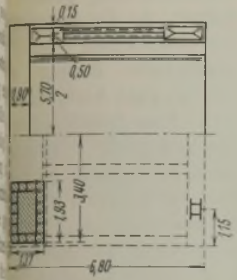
Draufsicht und Grundschnitt in Abb. 4 dargestellten Widerlagers.
